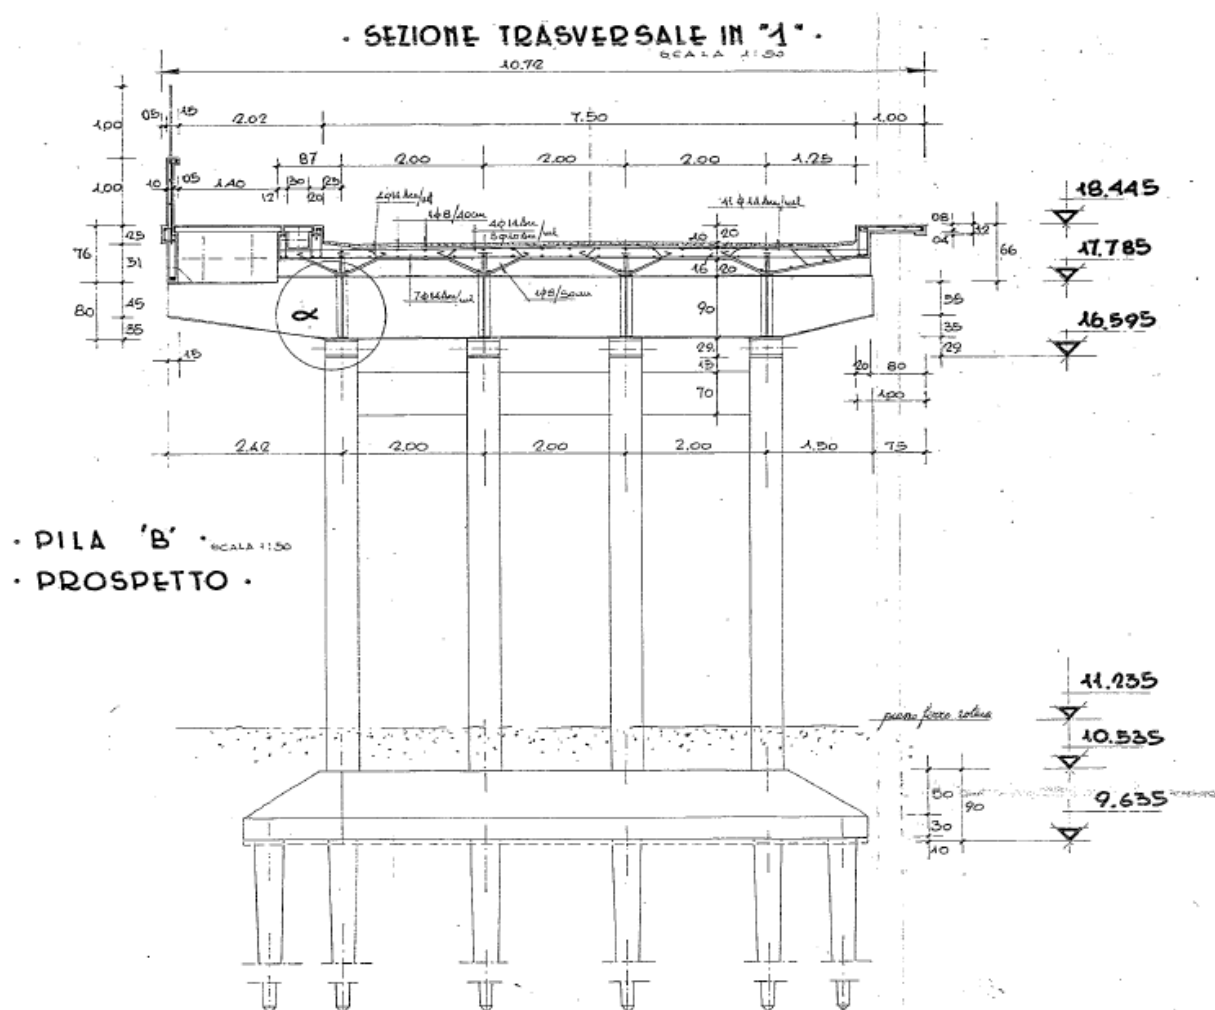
Estratto della tavola 1658/1b redatta dalla ditta SALC nel 1959 – Sezione trasversale
